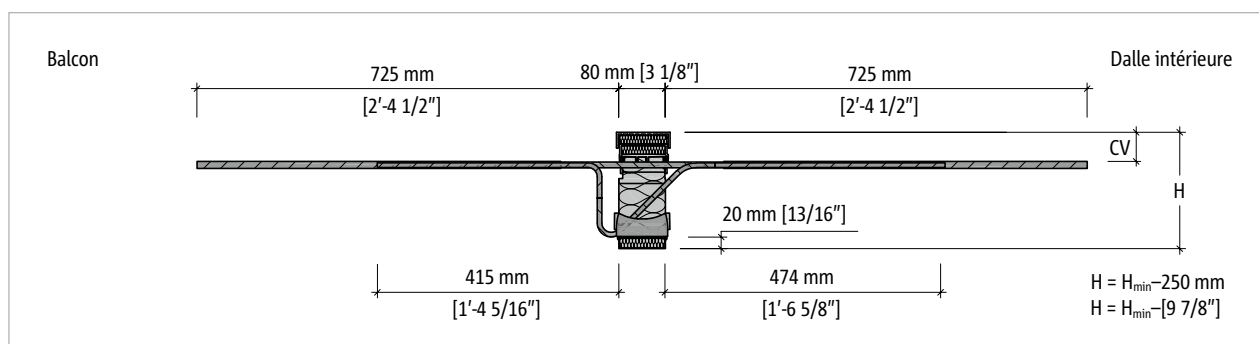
Schöck Isokorb® T Type CK-M6-V3 à M11-V1 : coupe transversale du produit
